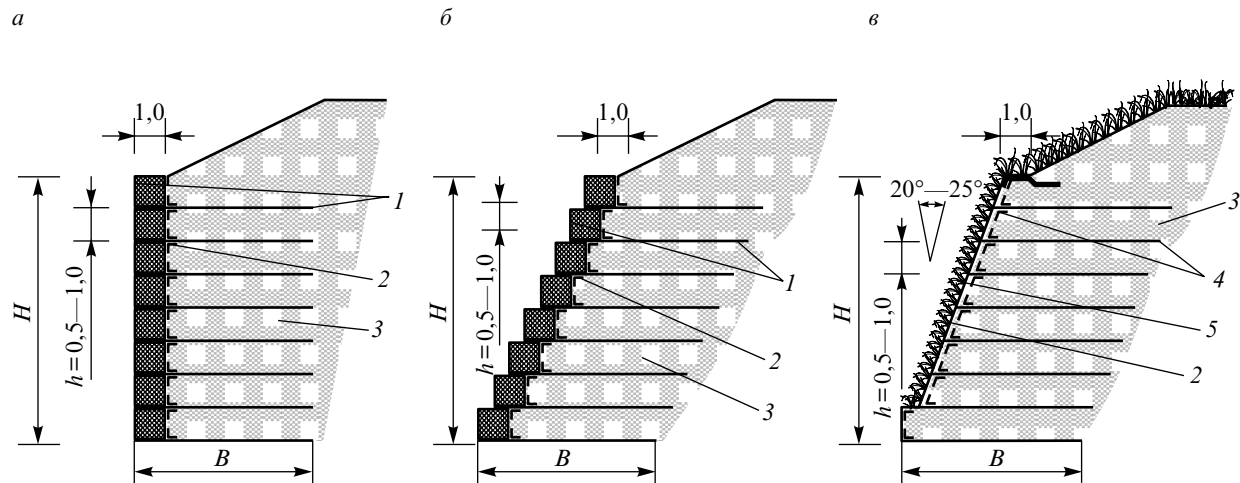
Армогабионы (Террамеш) конструкции стены:
